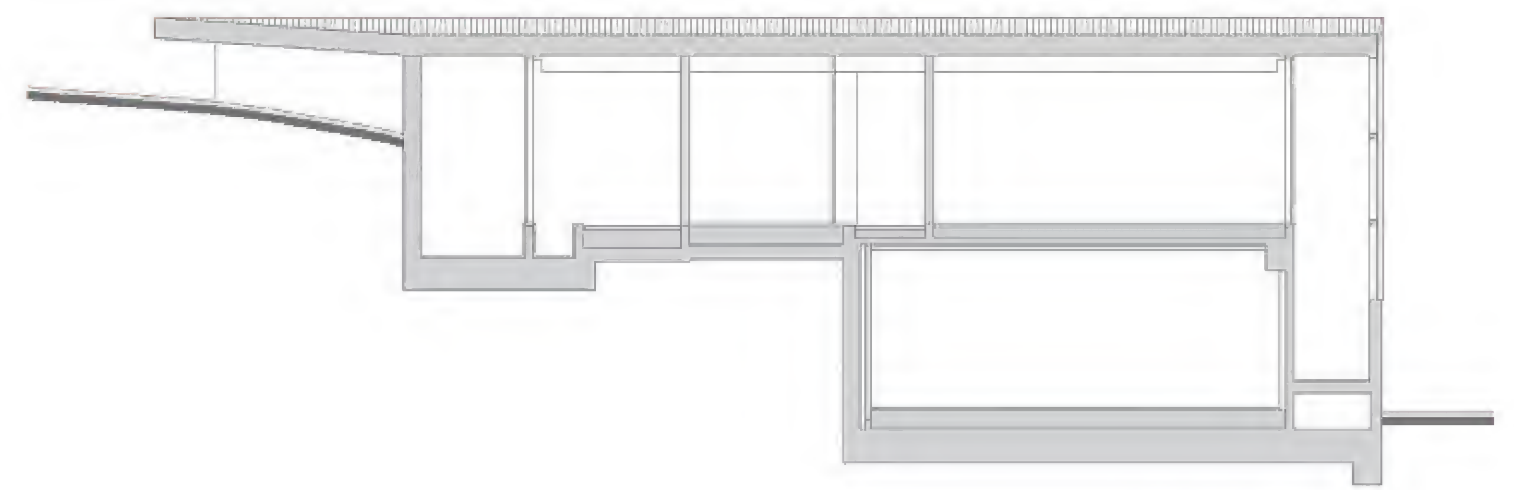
DETAIL A: KONSTRUKTIONSSYSTEM
